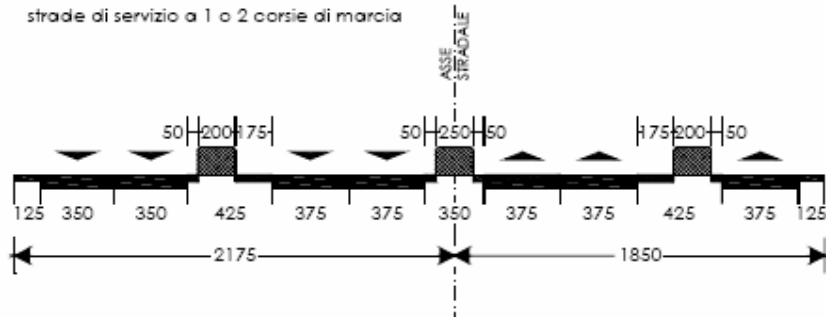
Caratteristiche geometriche delle piattaforme stradali di tipo B
